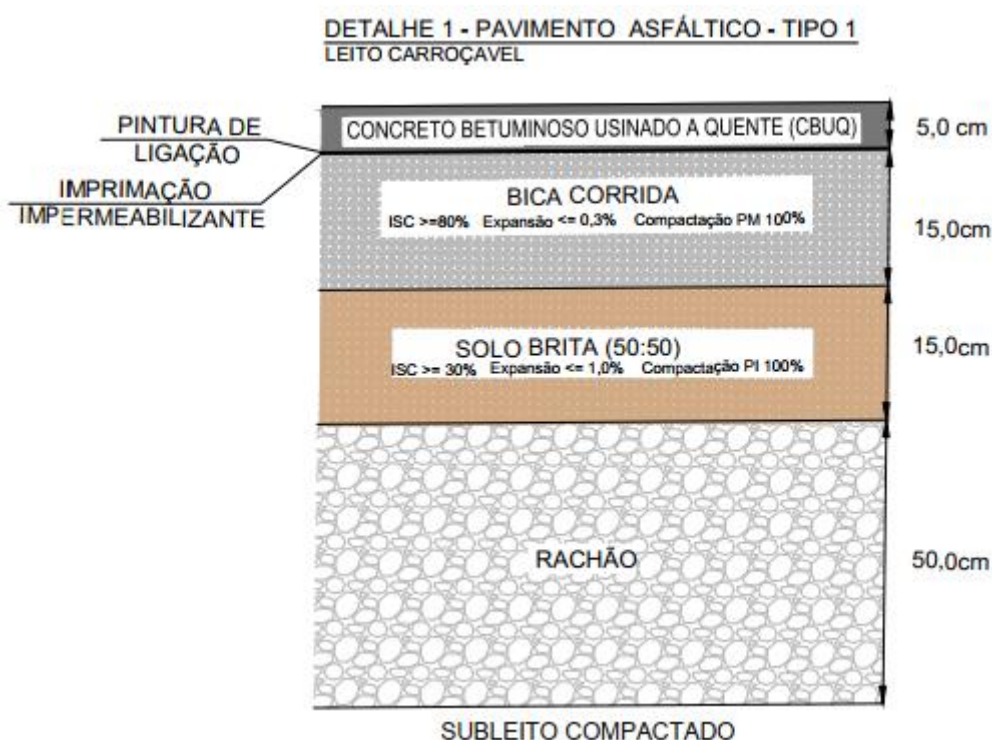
Pavimento Flexível da Via – Tipo 01
